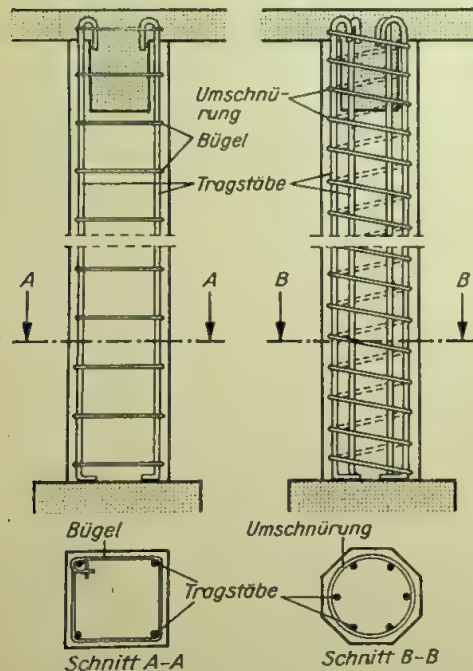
Bügelbewehrte und umschnürte Stütze
